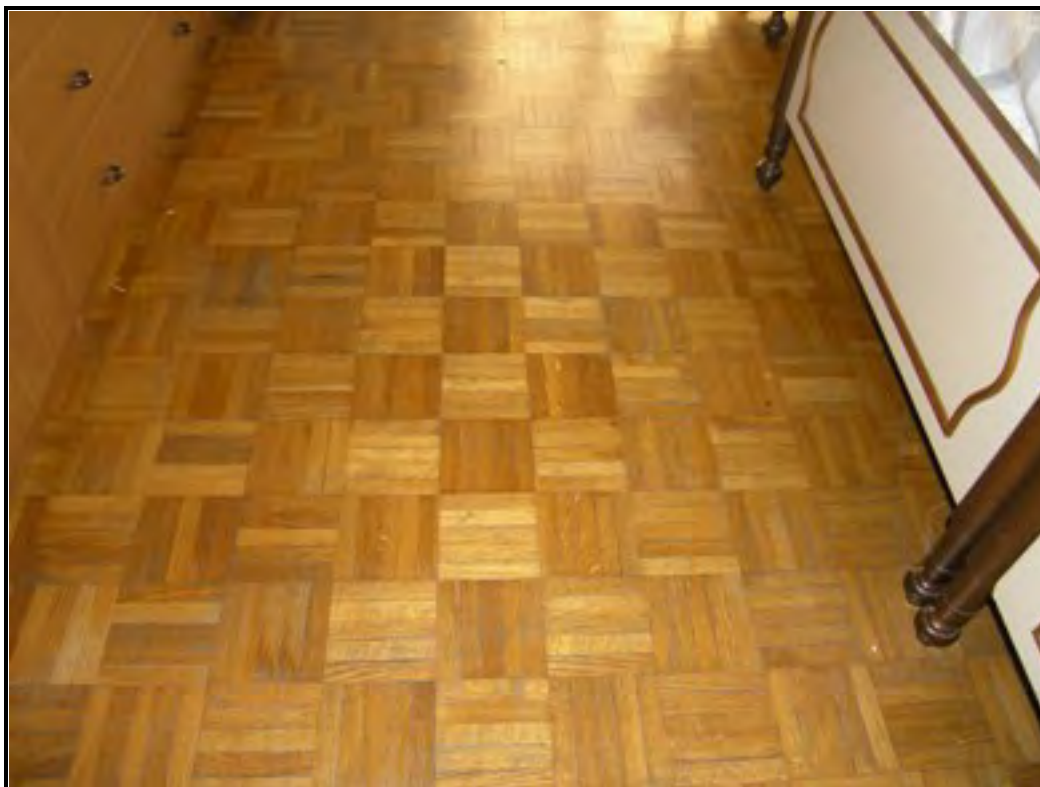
Prima camera da letto - Particolare pavimento in parquet
